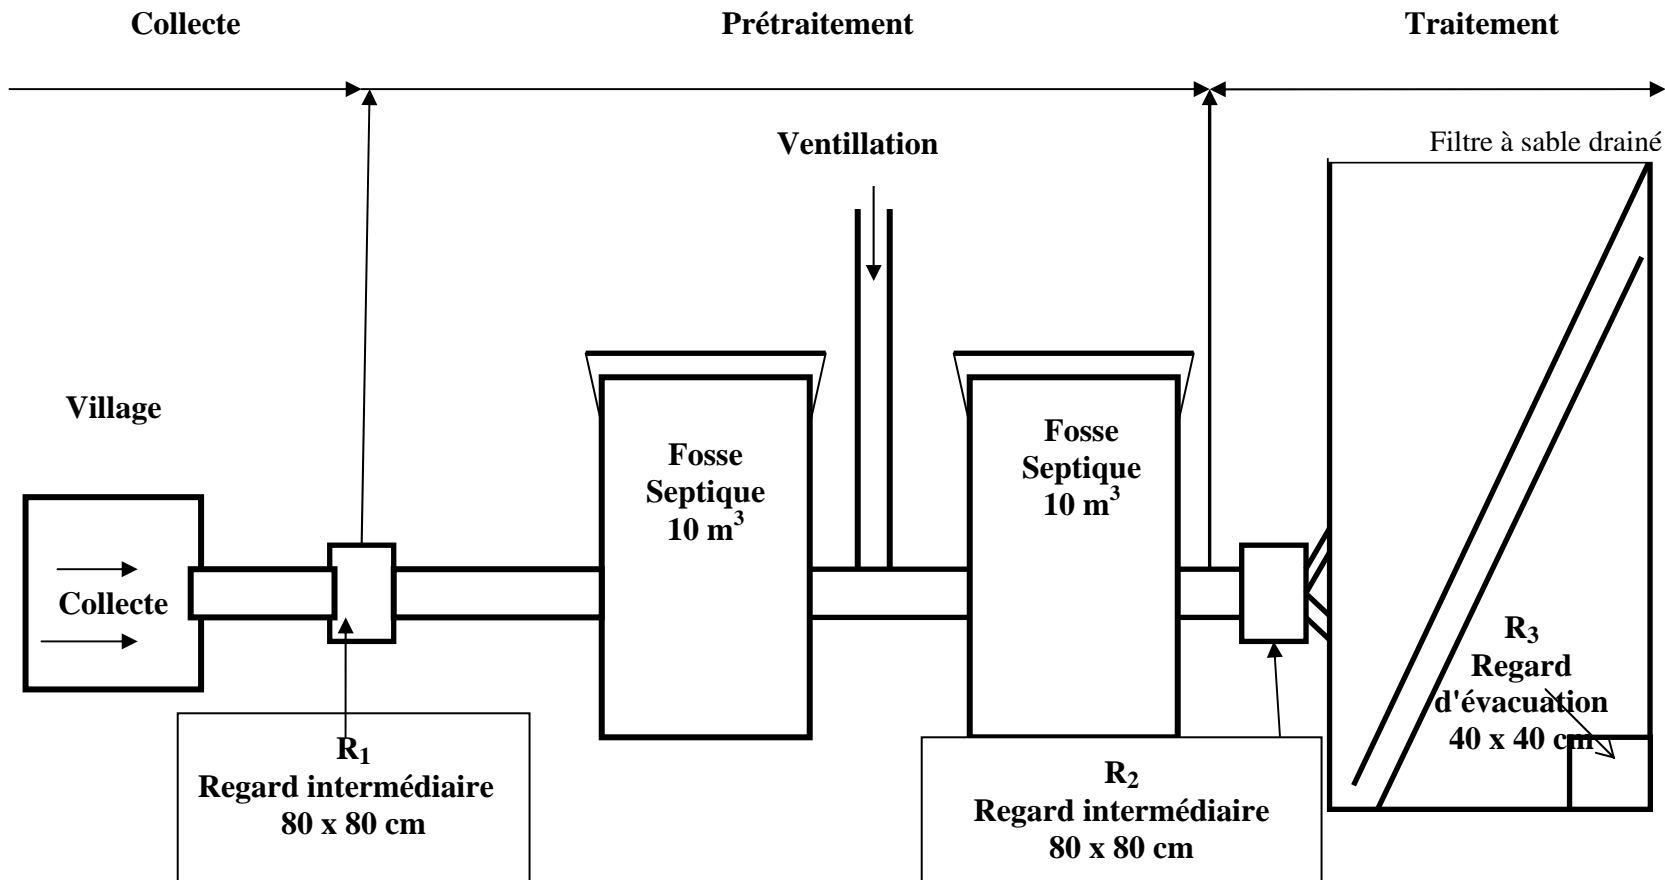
Schéma de l'installation d'assainissement autonome [Ain – Loussig]
